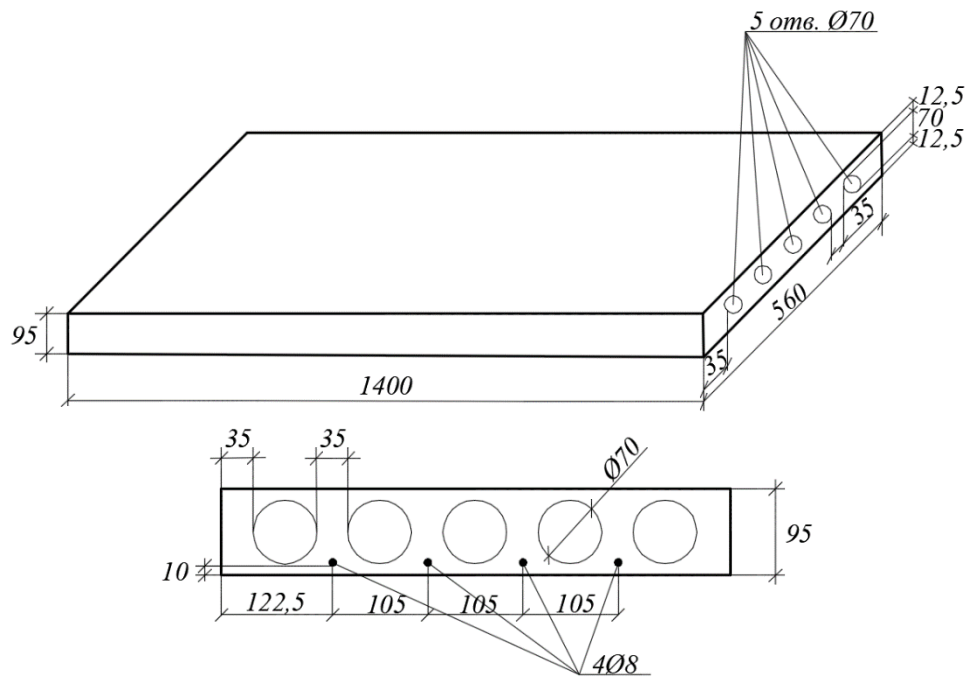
Модель залізобетонної багатопустотної плити перекриття
